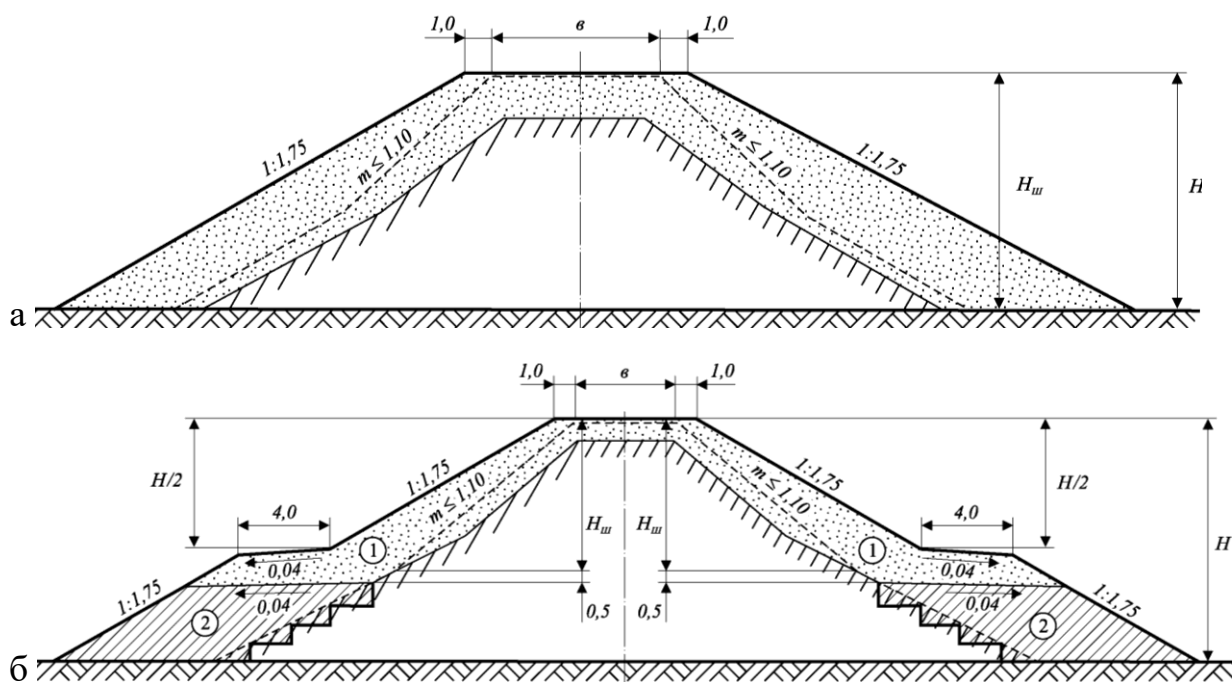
Примеры групповых технических решений насыпных сооружений (плотин, дамб, транспортных насыпей) высотой от 5 до 20 м при крутизне основания: а - до 1:20; б – более 1:20
